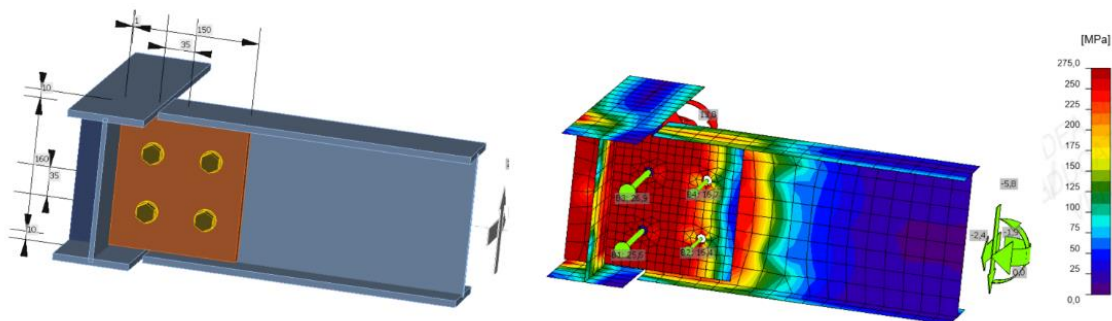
Ligação aparafusada entre perfis IPE180 – Tipo “T”.
